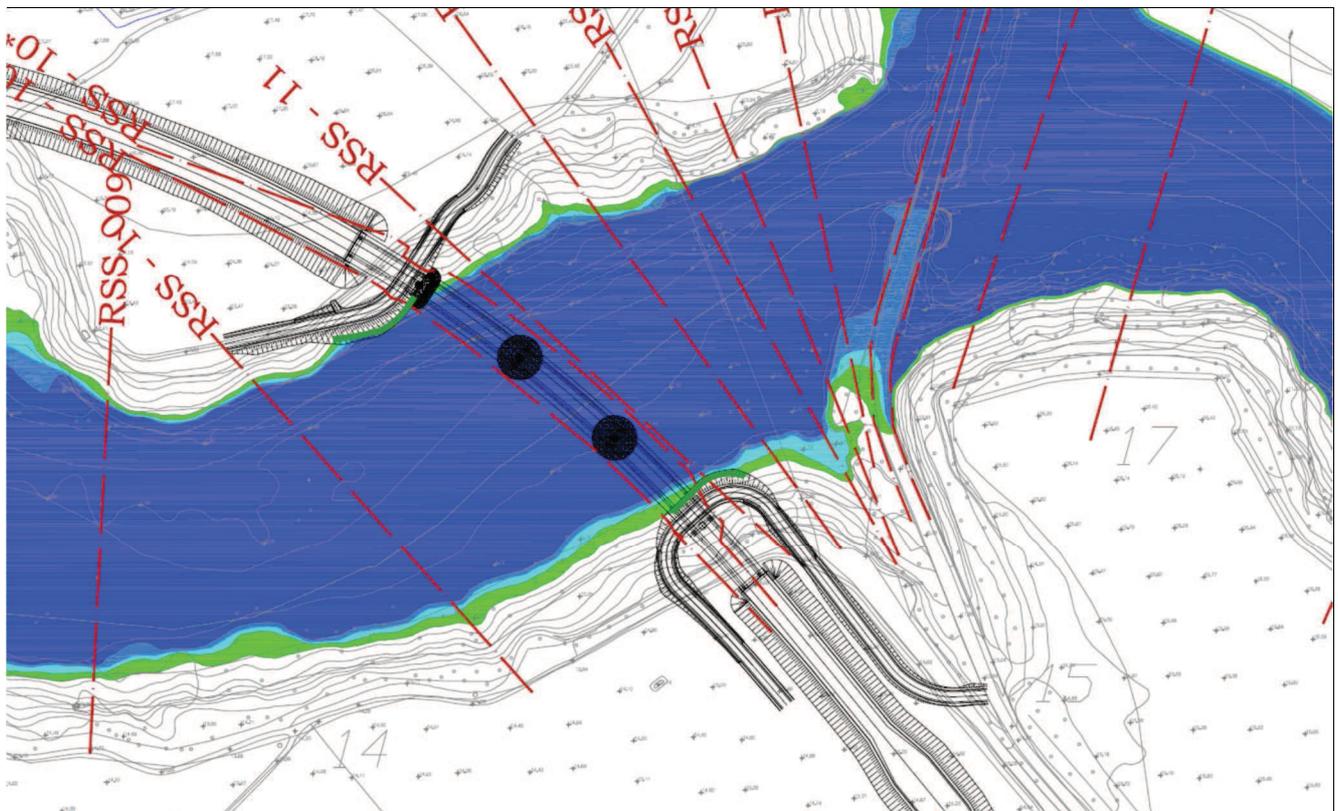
Viadotto Sassu. Planimetria delle aree di esondazione Post-operam
